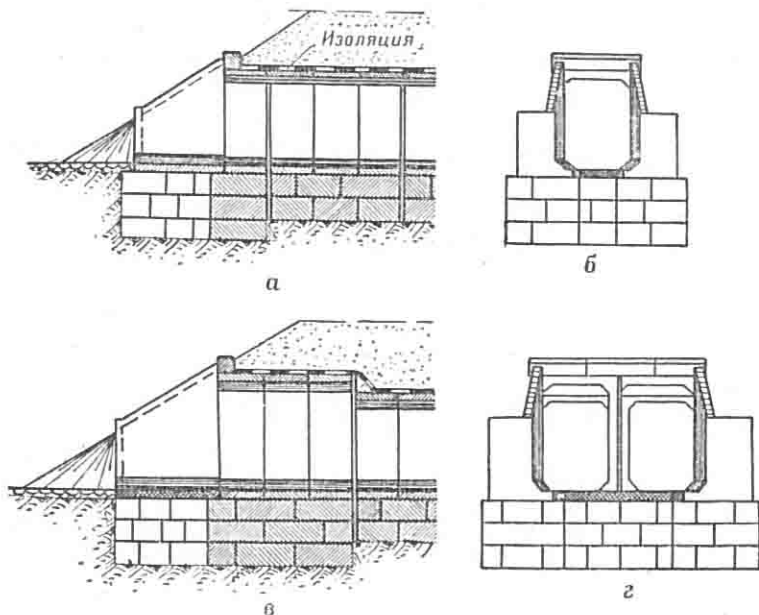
Прямоугольные блочные железобетонные трубы отверстием 2,0–6,0 м:
